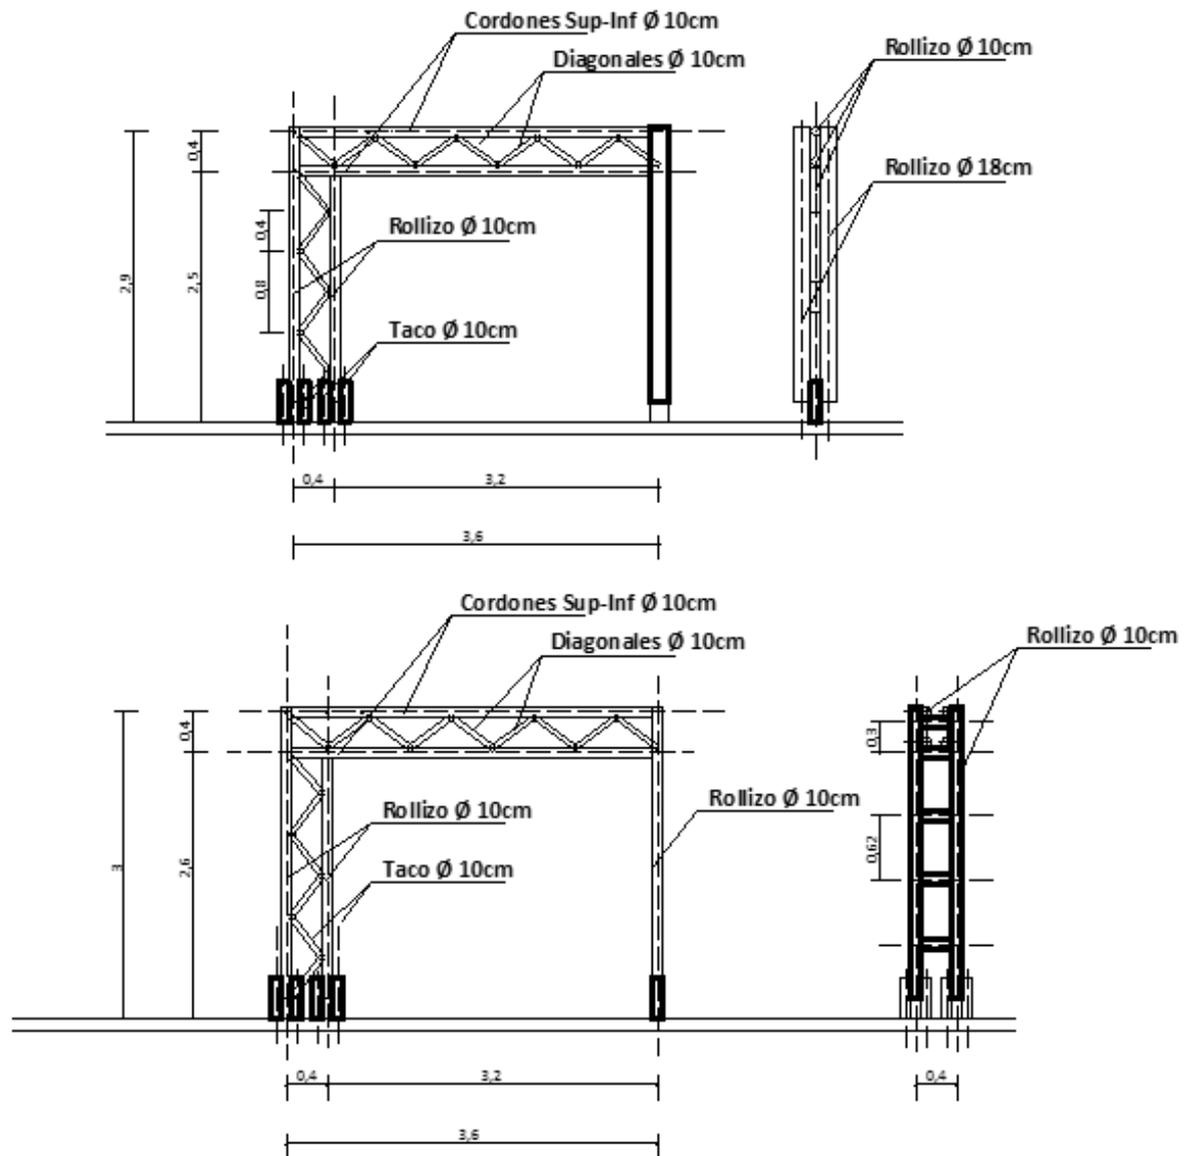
Esquema estructural de los pórticos utilizados en la vivienda, pórtico tipo (arriba) y pórtico de la fachada con doble cercha (abajo).
